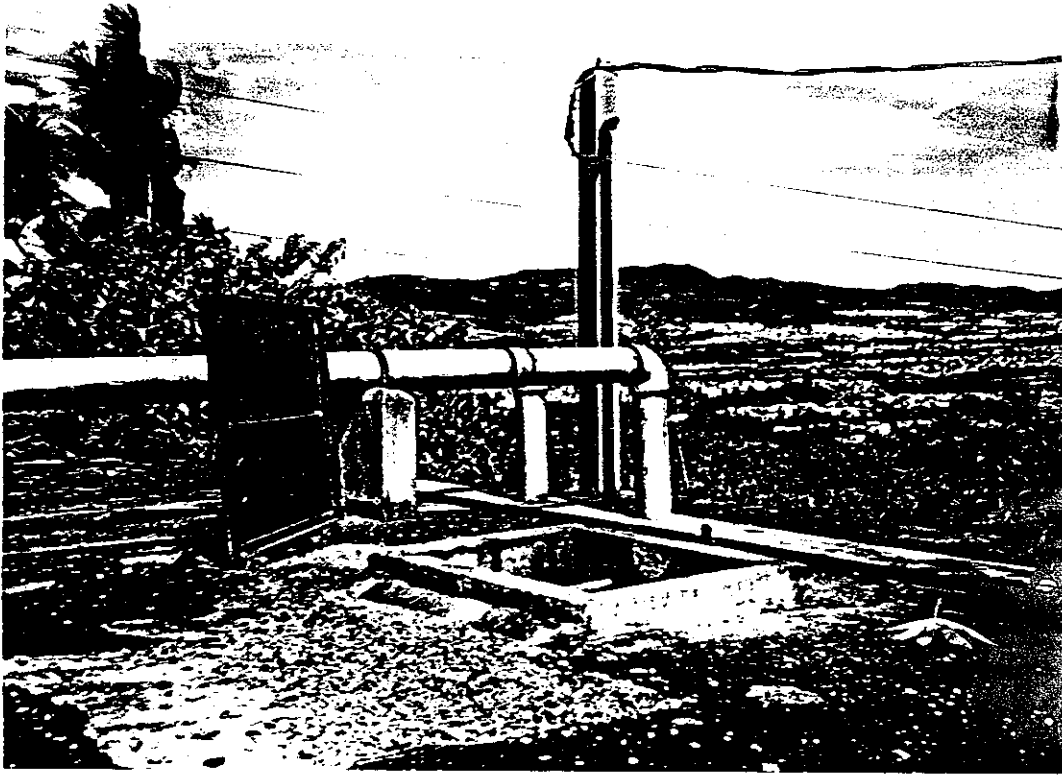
Se aprecia el mal estado de la tapadera de inspección
